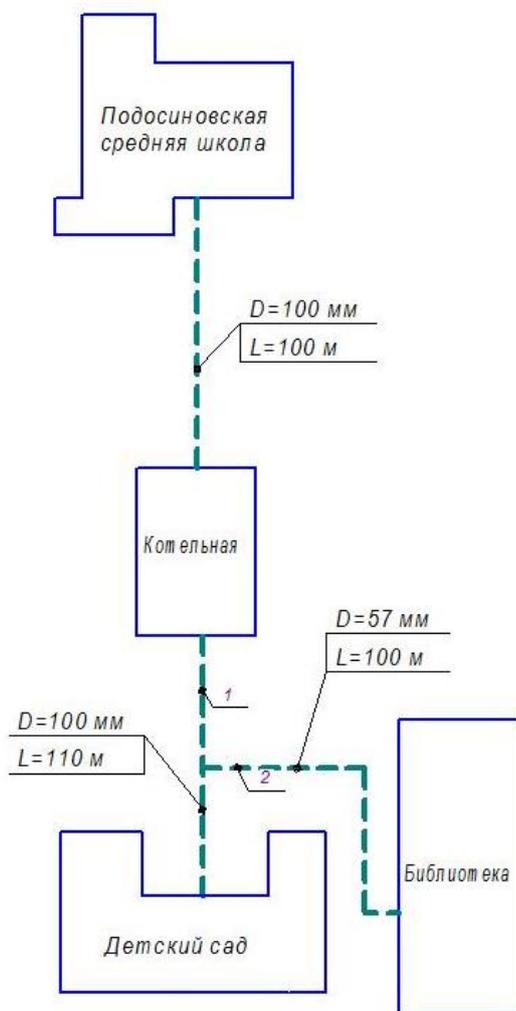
Схема тепловых сетей котельной №2
